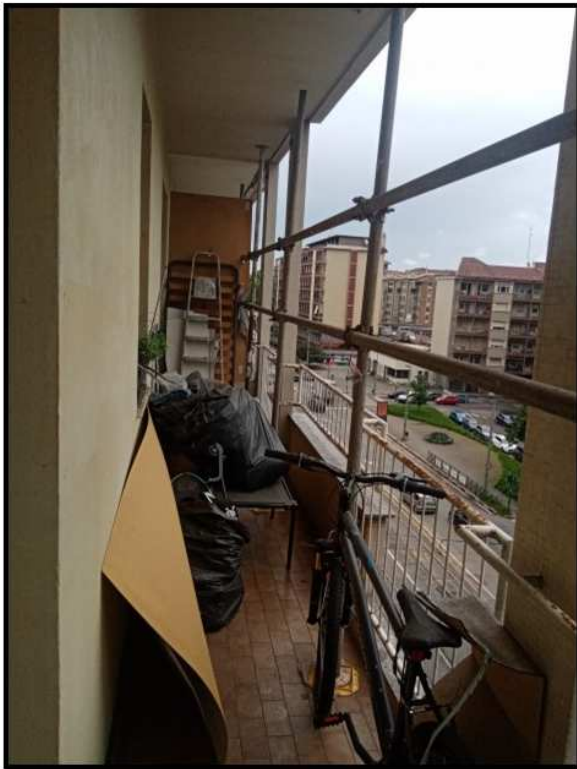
16 balcone con affaccio su corso Giulio Cesare
